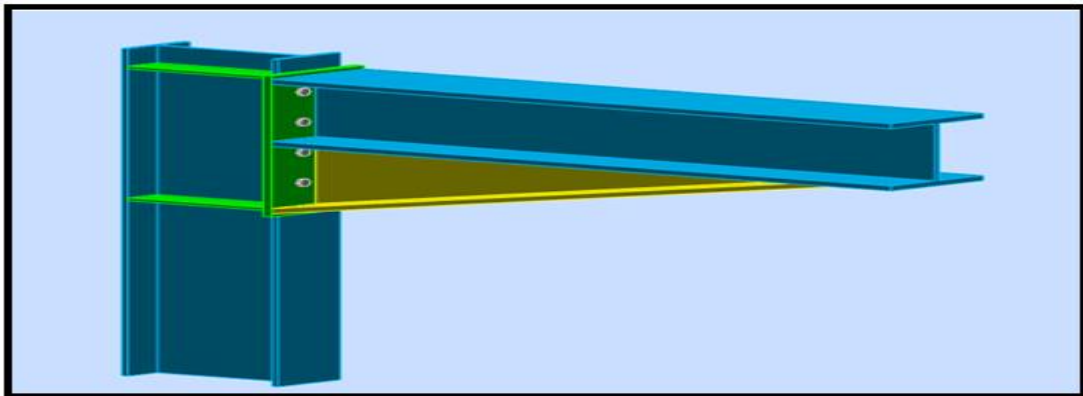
Vue en 3D de l'assemblage poteau- console de la poutre de roulement
